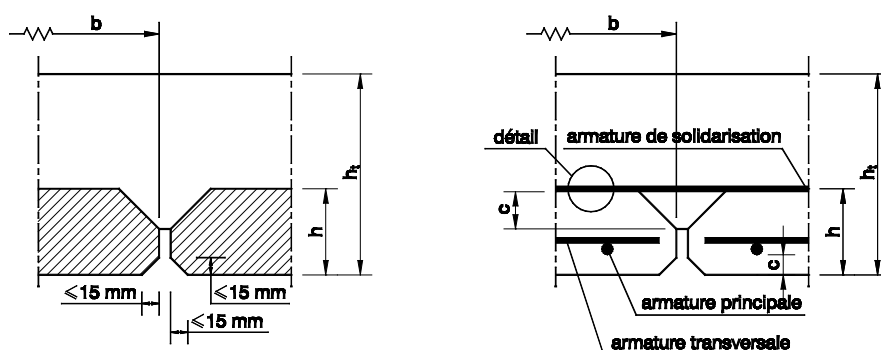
b -Prédalles avec bord latéral chanfreiné supérieur : Liaison transversale avec armatures horizontales
